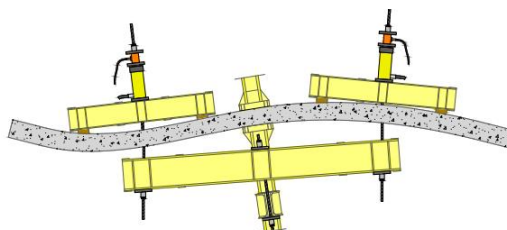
Sistema que garante a aplicação constante da carga vertical, na posição de deformada devido a cargas vertical e horizontal. [7]
